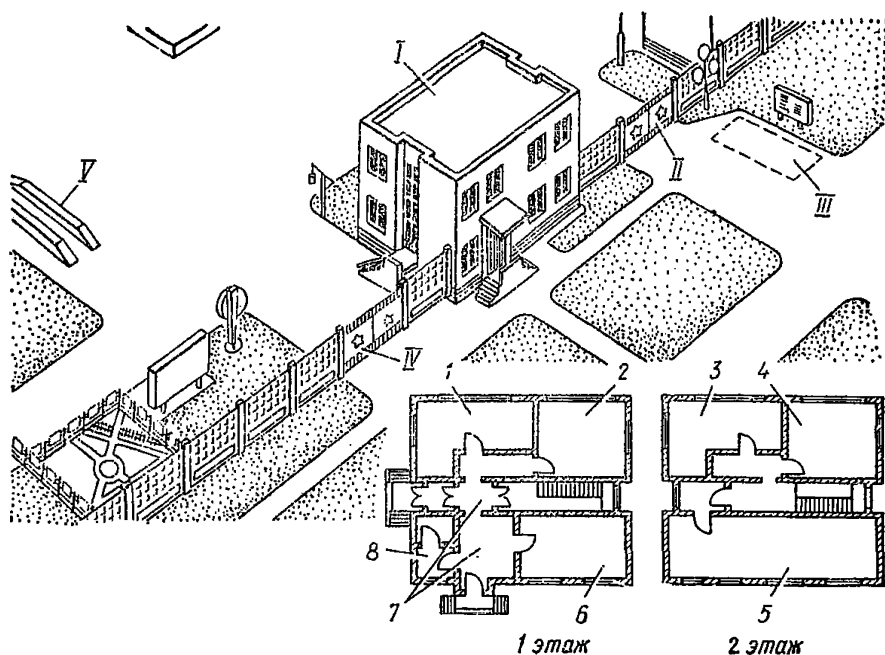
Вариант планировки КТП с двухэтажным зданием:
